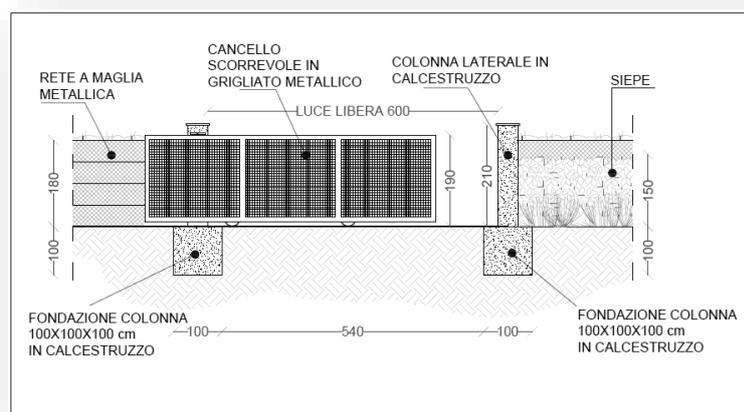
elaborato 53 (DISEGNI ARCHITETTONICI Recinzione tipo impianto fotovoltaico)
